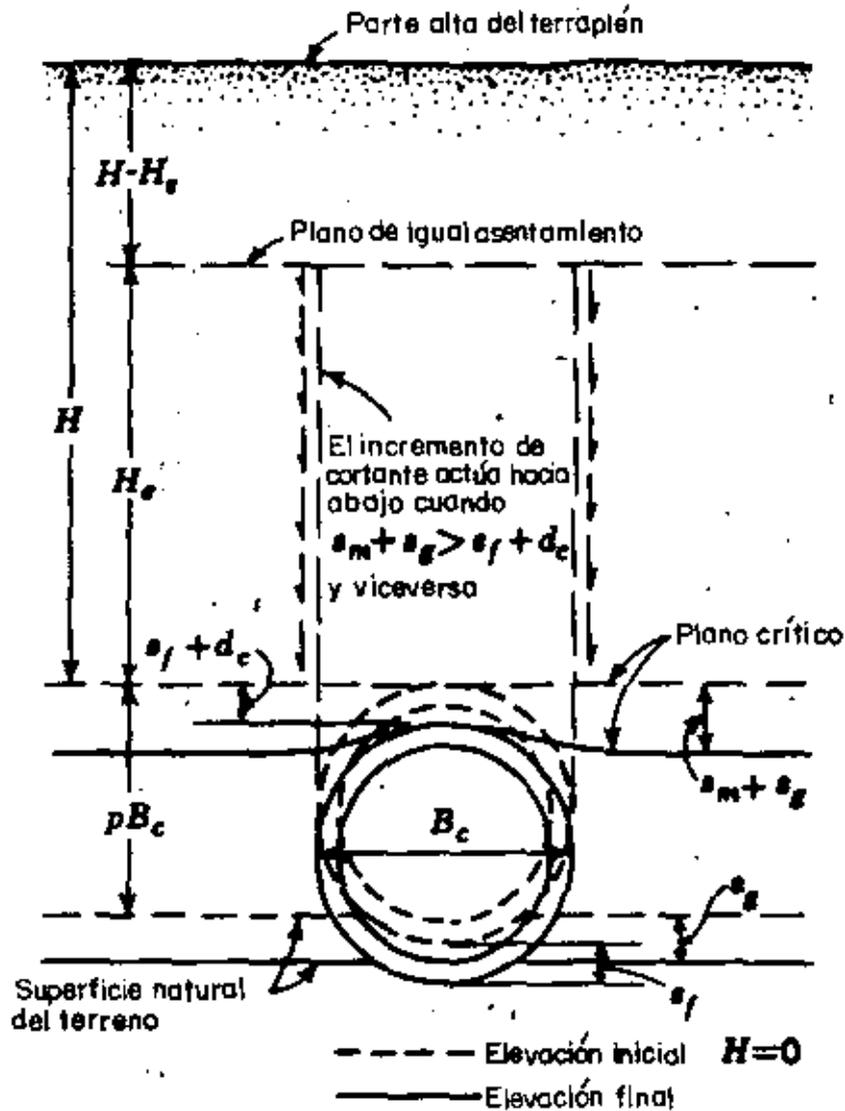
ASENTAMIENTOS QUE INFLUYEN EN LAS CARGAS DE CONDUCTOS CON PROYECCION POSITIVA.
